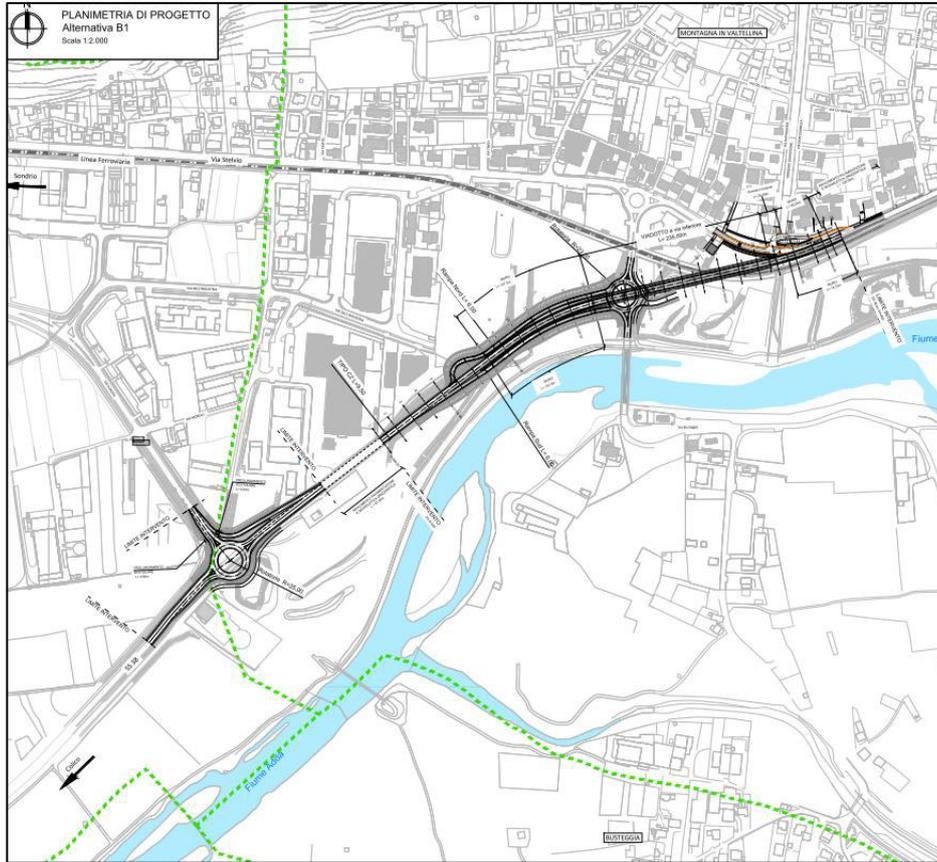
vi – Stralcio planimetria di progetto opere stradali,
